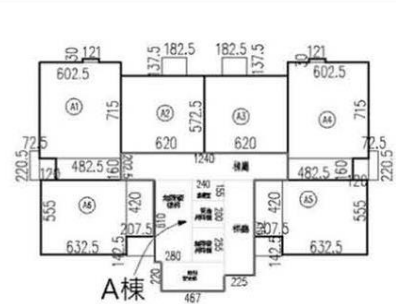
壹層防災計畫平面示意圖 S:1/300
